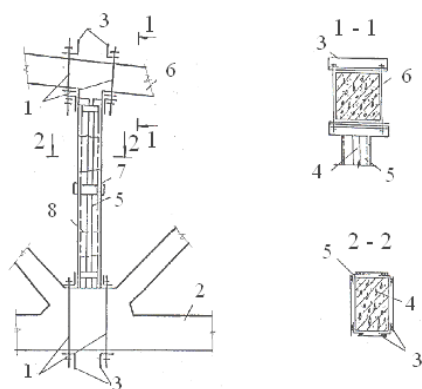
Вариант усиления стойки фермы с помощью предварительно напряженных металлических уголков:
